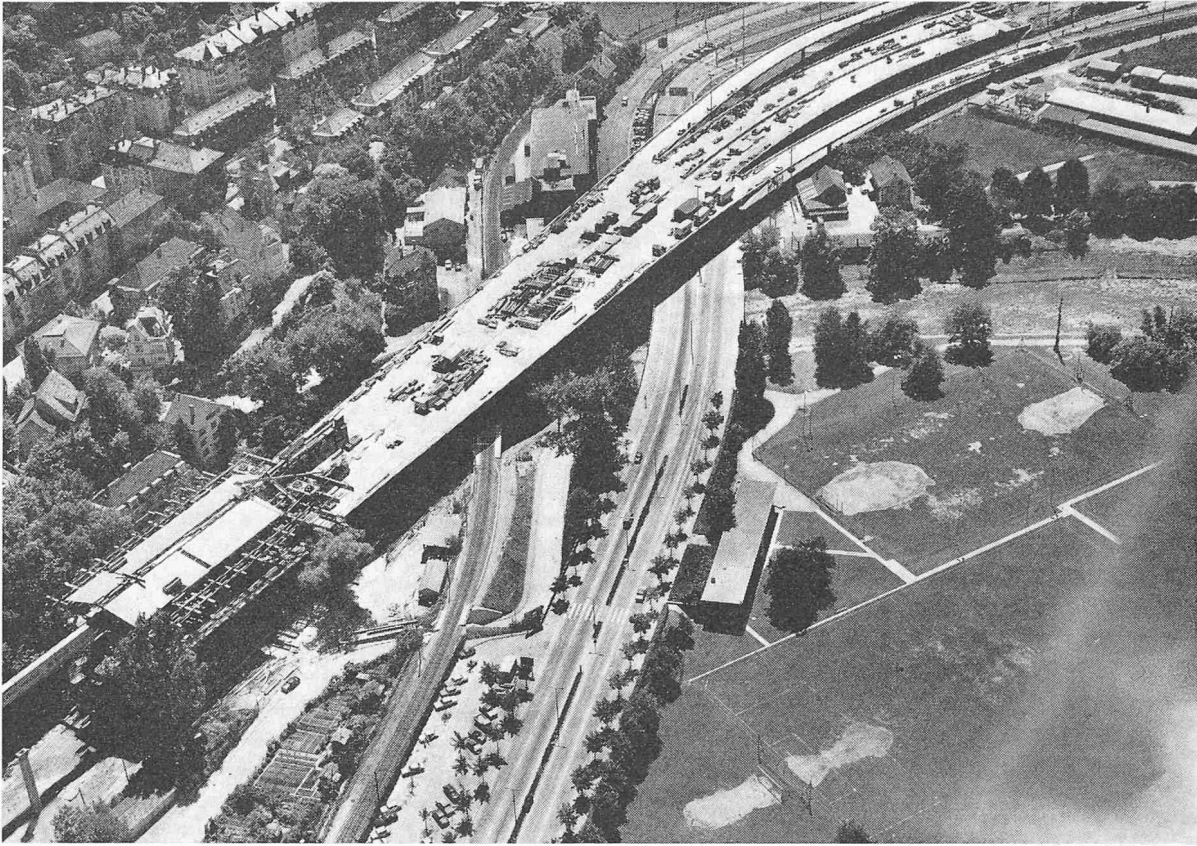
Sihlhochstrasse, Anschluss Brunau-Nord. Im Vordergrund links die Baustelle mit dem Vorschubgerät, Mitte Sihltalbahn und Allmendstrasse. Von Nordwesten gesehen (Photo Comet, Zürich)
